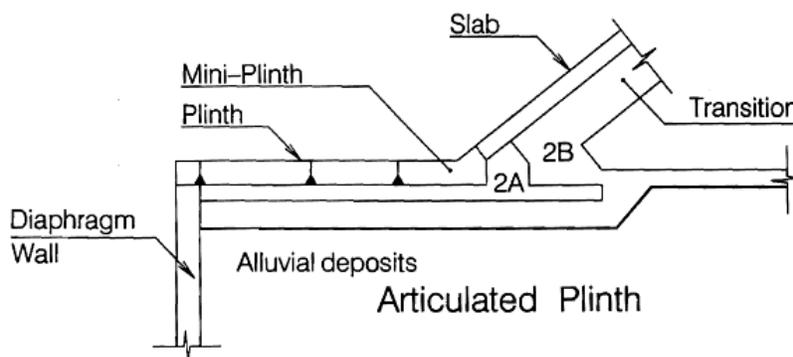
Plinto articulado usado en presa Santa Juana y Plucaro
